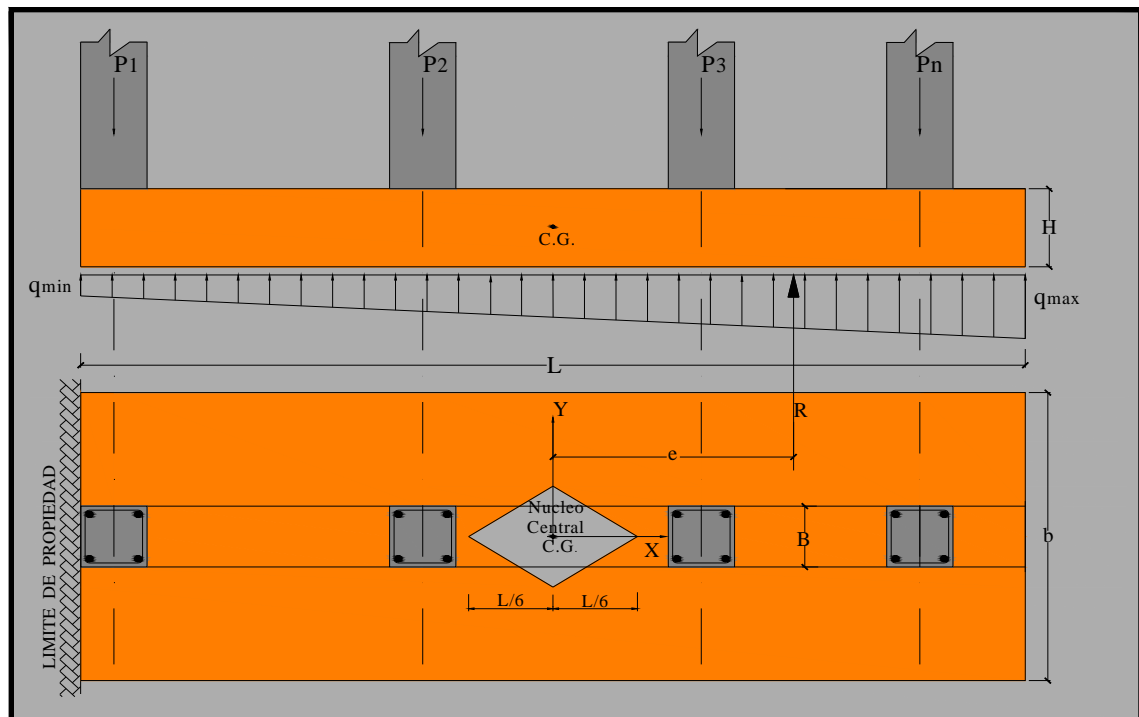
Vigas de fundación (Núcleo Central)
